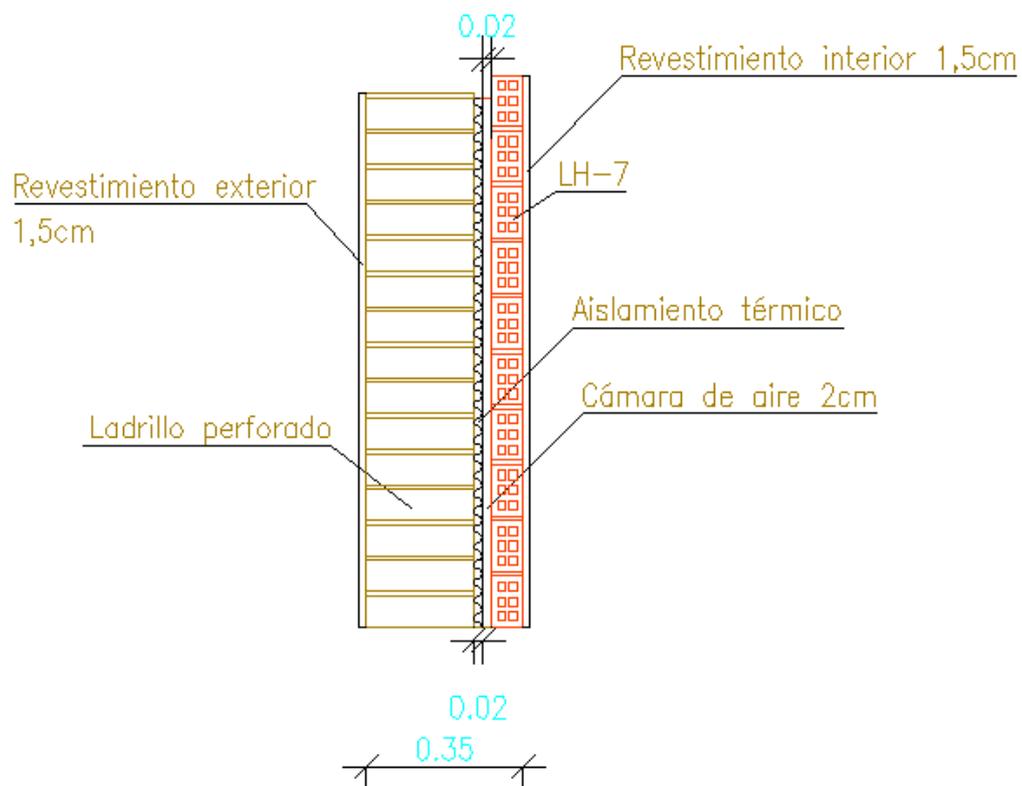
Detalle constructivo del muro exterior según proyecto.
